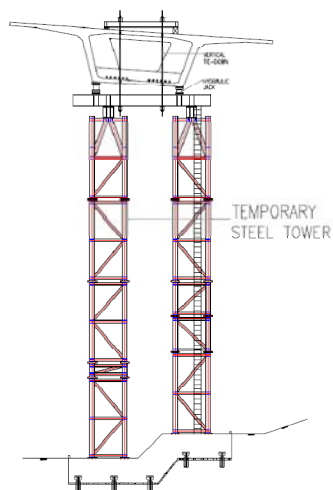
Esquemática de uma torre metálica estabilizadora.
